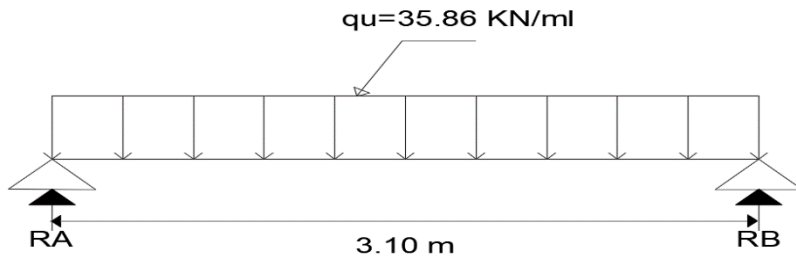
Schéma statique de la poutre palière à ELU
